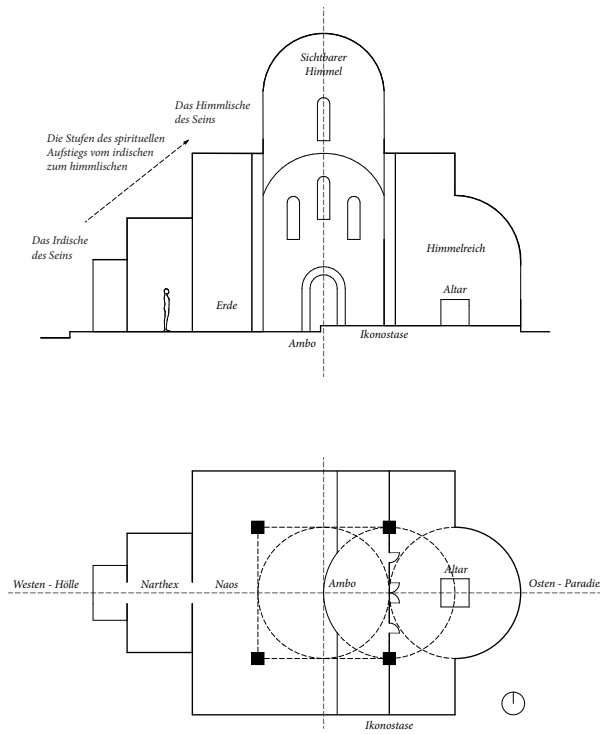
Schematischer Schnitt und Grundriss einer Kreuzkuppelkirche mit Symbolik
